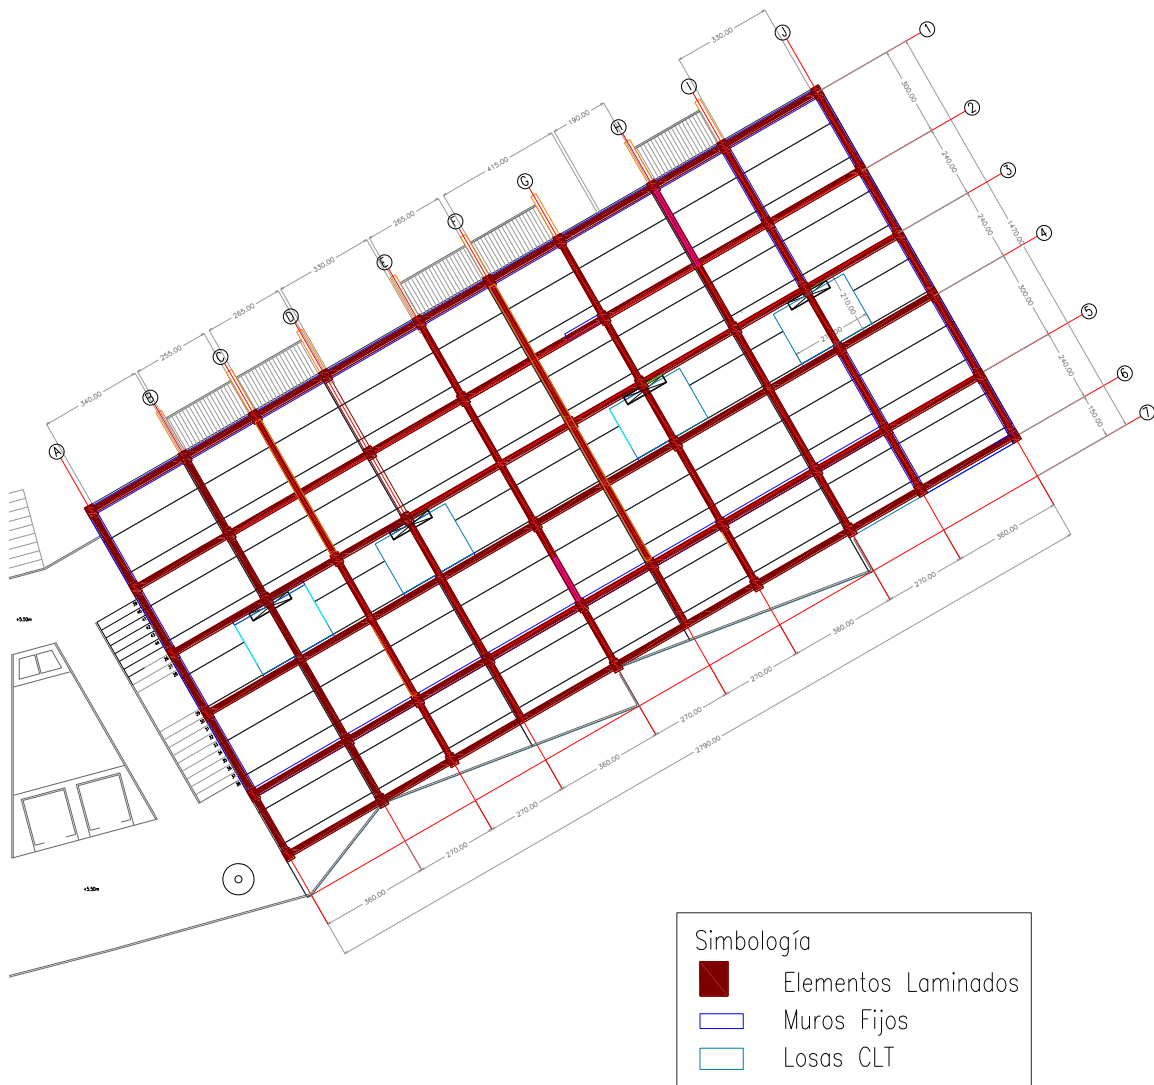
Plano Estructural Primer Nivel de Hormigón. Casa Metamorfosis.
